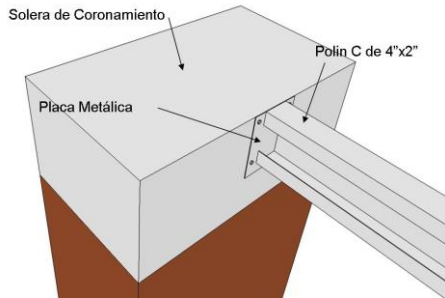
Polín de estructura de techo soldada a placas metálicas en solera
